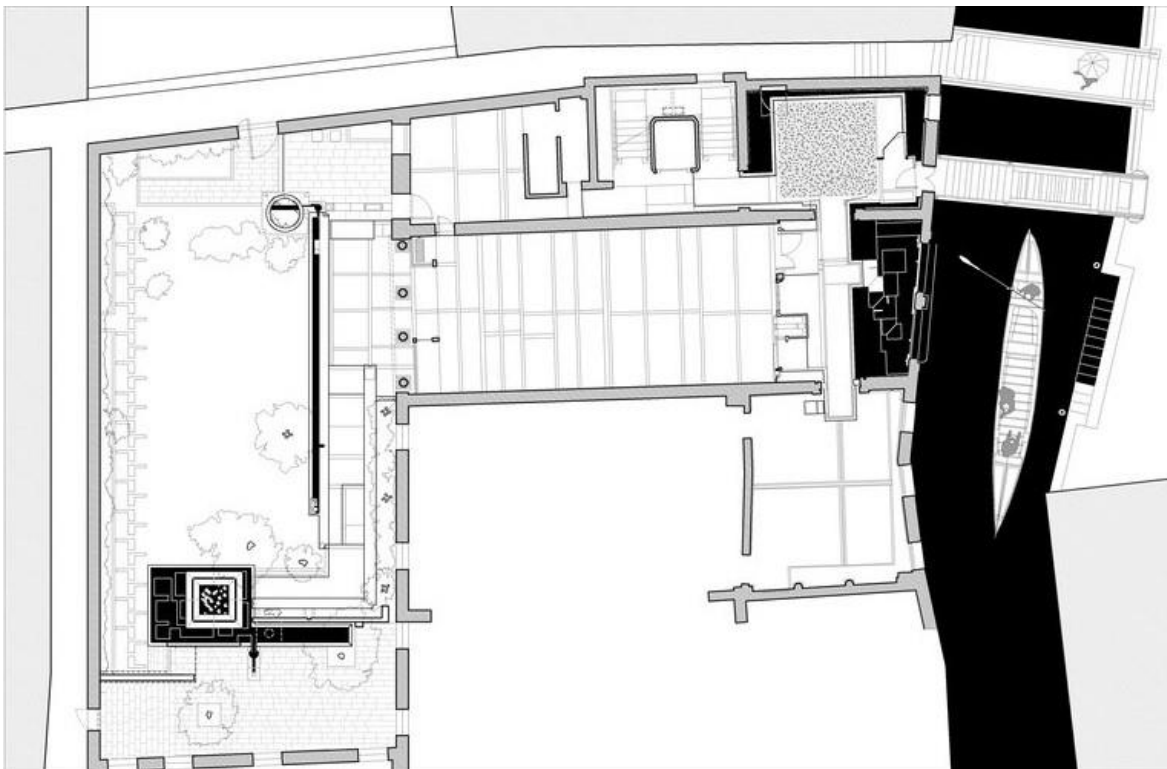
| Planta Fundação Querini Stampalia, Veneza, Carlo Scarpa, 1961-63 (Arquine, 2020)
